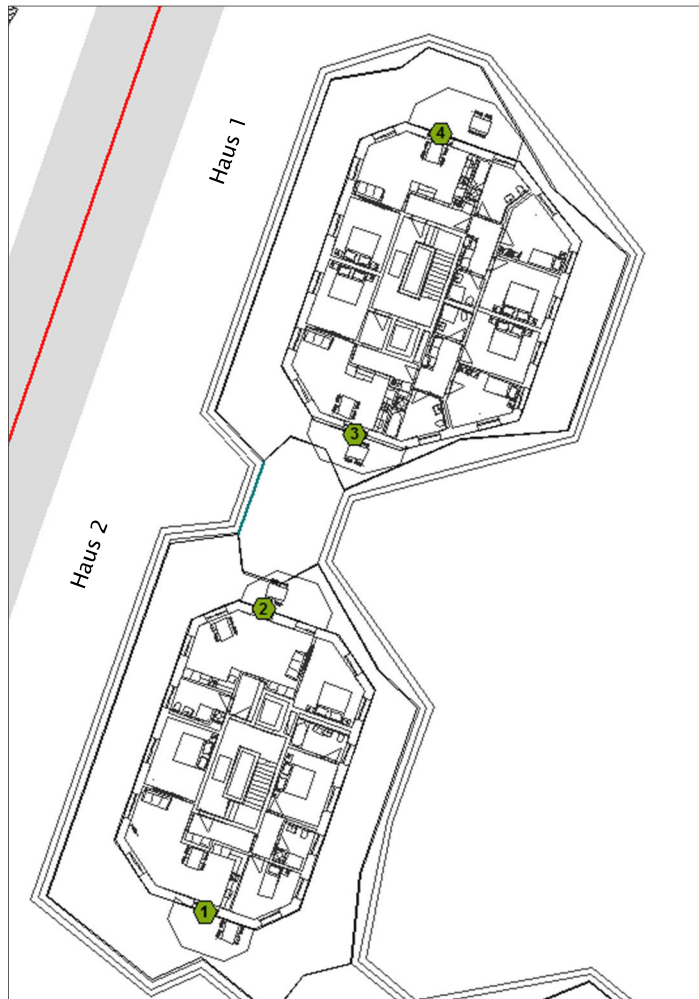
Dachgeschoss Haus 1 und 2 mit Immissionsorten
